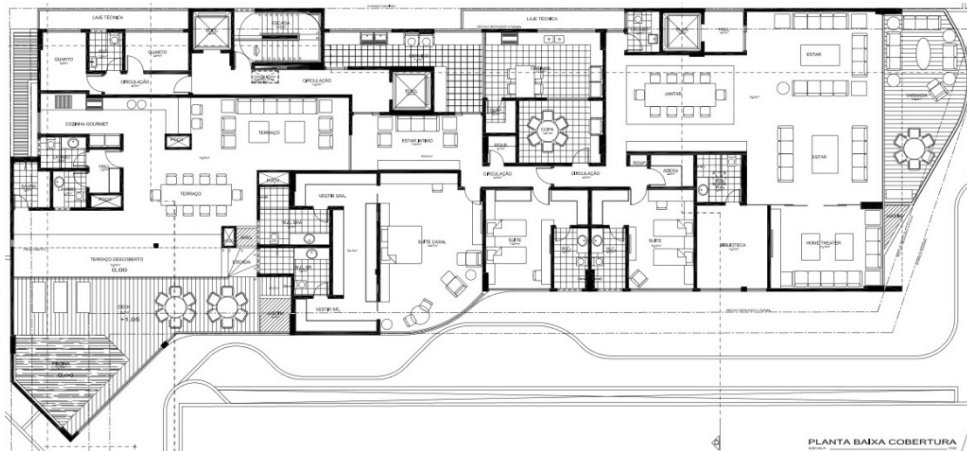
Planta baixa do pavimento superior da cobertura *duplex*, terminação 02 do edifício Grand Classique
